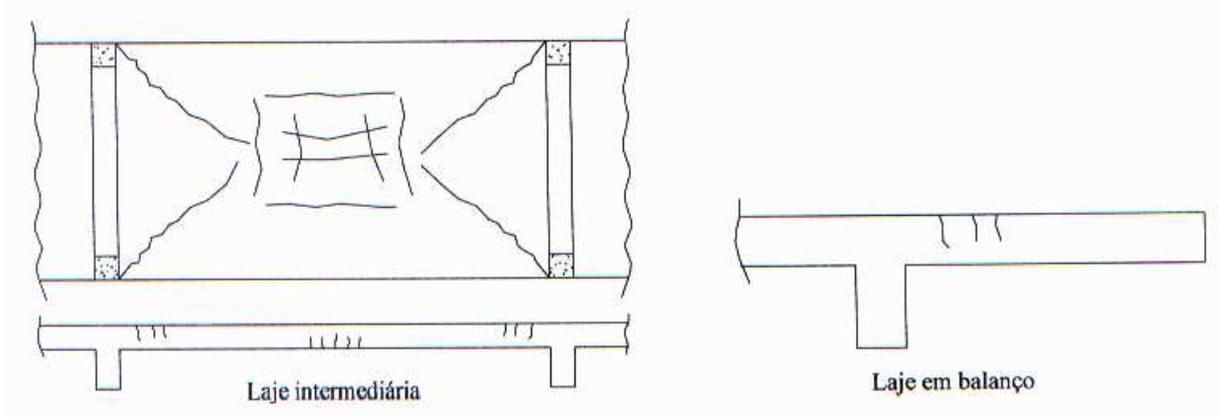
Configuração da fissuração por flexão em lajes
